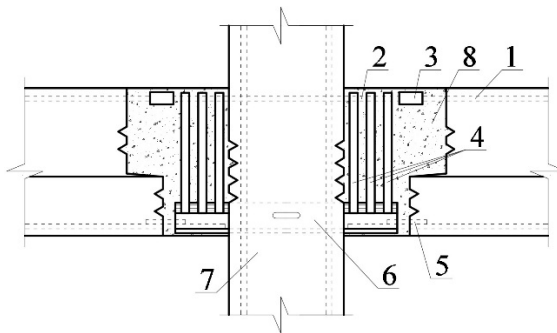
Армирование сборного рамного узла: 1 – выпуски арматуры из ригеля; 2 – выпуски арматуры из колонны; 3 – сварные соединения; 4 – поперечные стержни усиления; 5 – усиление выпусков арматуры из ригеля; 6 – опорный столик из уголков с отверстием для бетонирования; 7 – колонна; 8 – бетон замоноличивания
